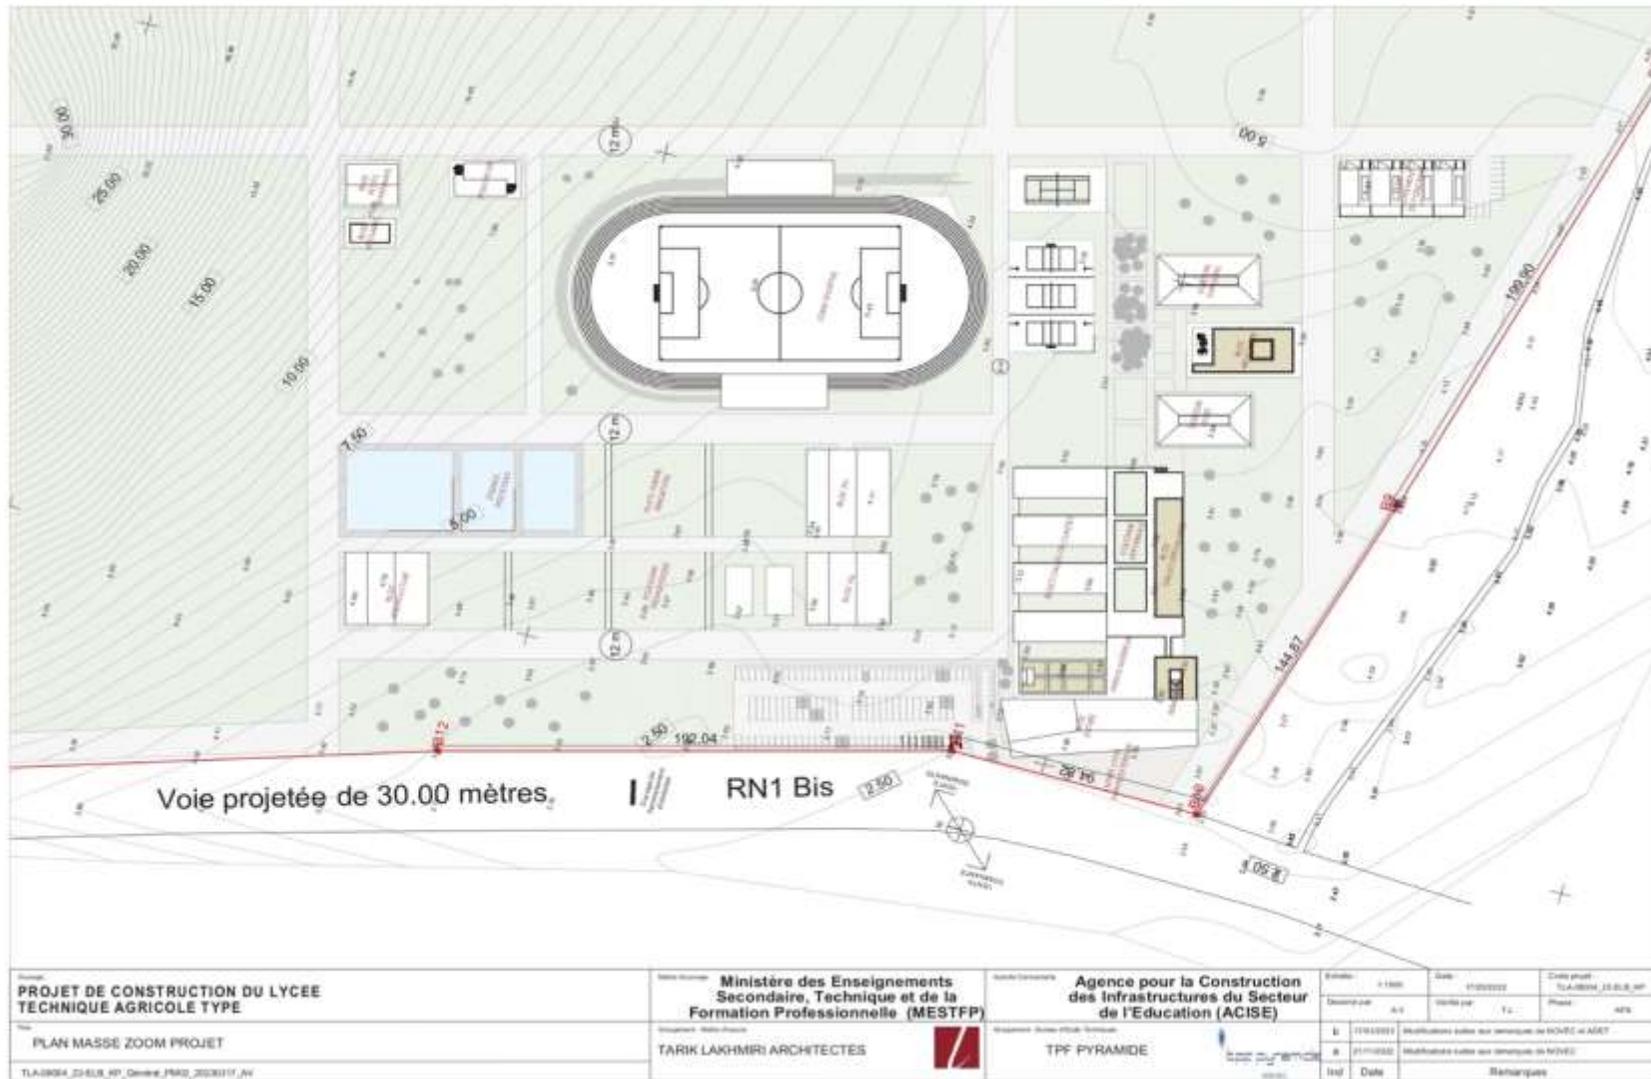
Plan de masse type de construction du Lycée Technique Agricole de Kétou (Zoom)
